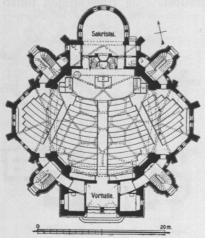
Gnadenkirche in St. Pauli, Grundriß.
